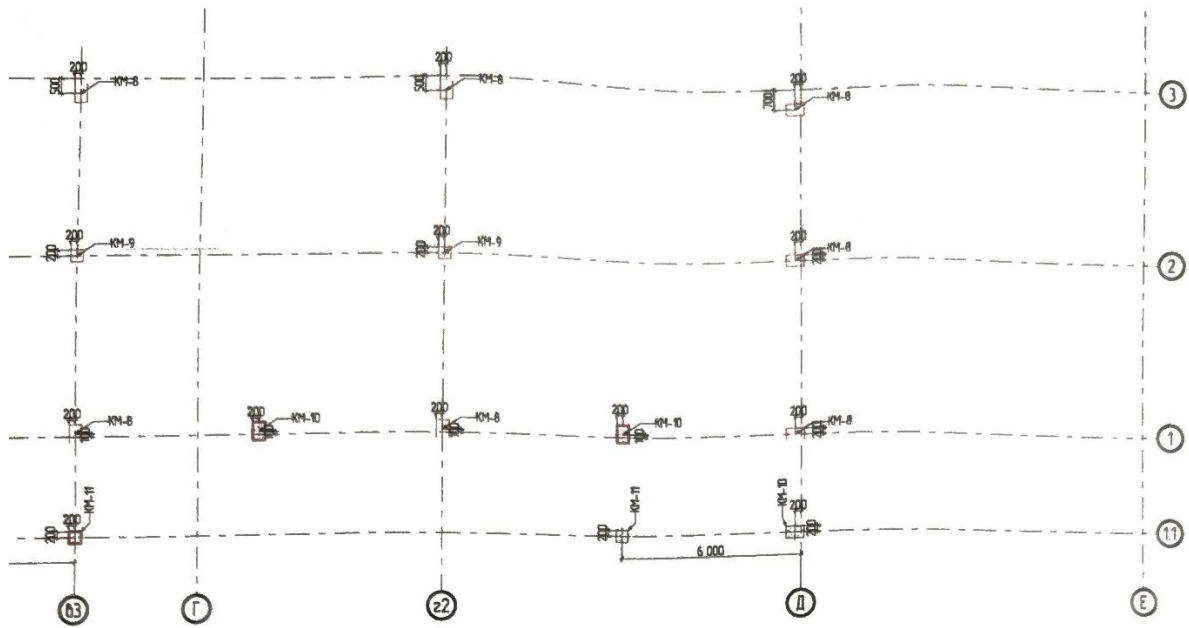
Фрагмент плану колон на відм. +3,700
